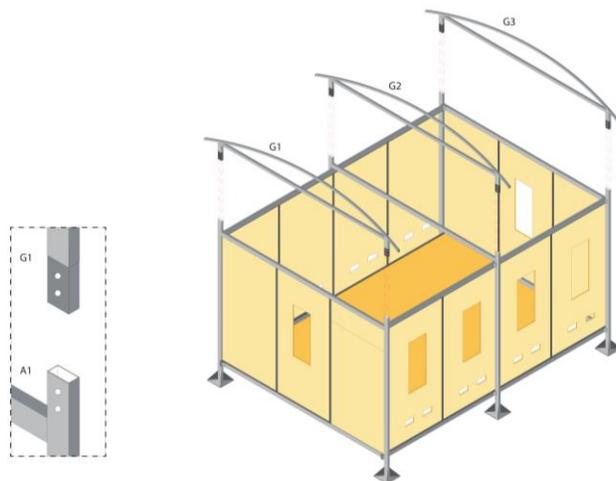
Acoplamiento de arcos estructurales de cubierta.
